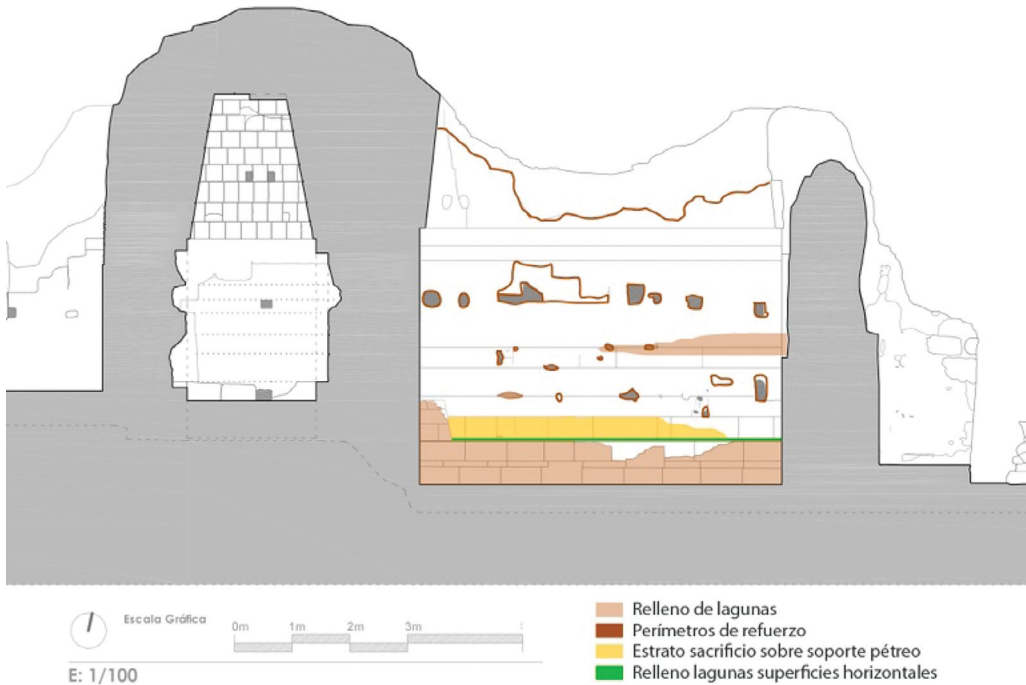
Propuesta para la reintegración del muro N, 6J2-4. Basado en plano de levantamiento arquitectónico del Proyecto La Blanca (Muñoz G., Matarredona N. y Marín B. 2007), modificado por la autora.
